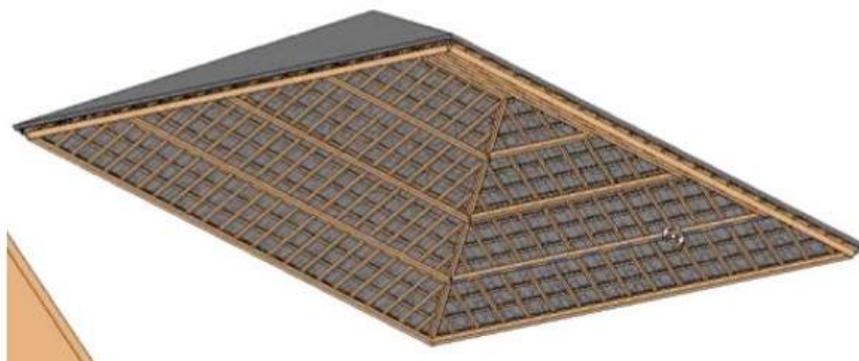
Exemplo de Telhado com Madeiramento no Autodesk Revit 01
